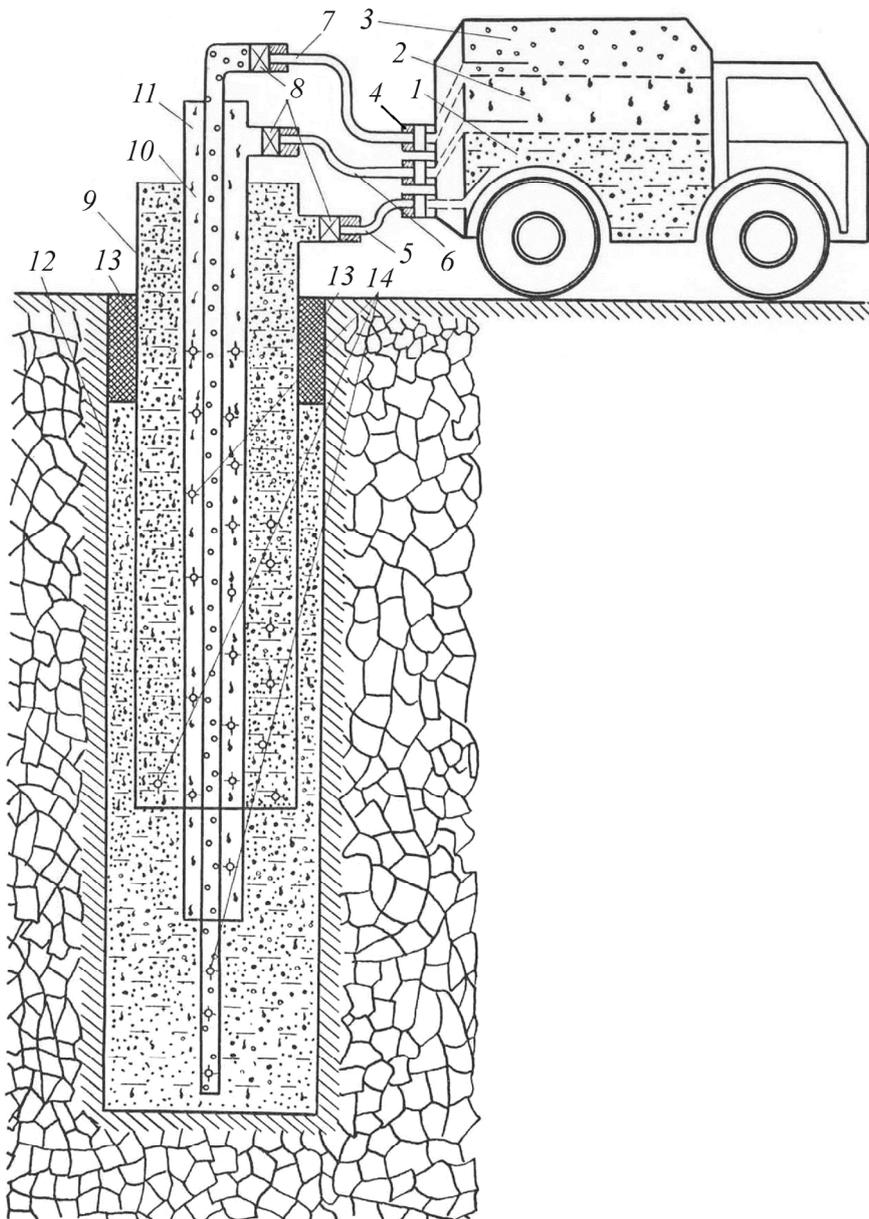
Способ предупреждения и тушения эндогенных пожаров: 1 — резервуар для известковой суспензии (пульпы); 2 — резервуар для стабилизатора пены; 3 — резервуар для пенообразователя; 4 — расходомеры; 5 — шланг подачи известковой суспензии; 6 — шланг подачи стабилизатора пены; 7 — шланг подачи пенообразующего вещества; 8 — регуляторы давления; 9 — обсадная труба; 10 — трубопровод подачи стабилизатора; 11 — трубопровод подачи пенообразующего вещества; 12 — скважина; 13 — цементное кольцо; 14 — отверстия
